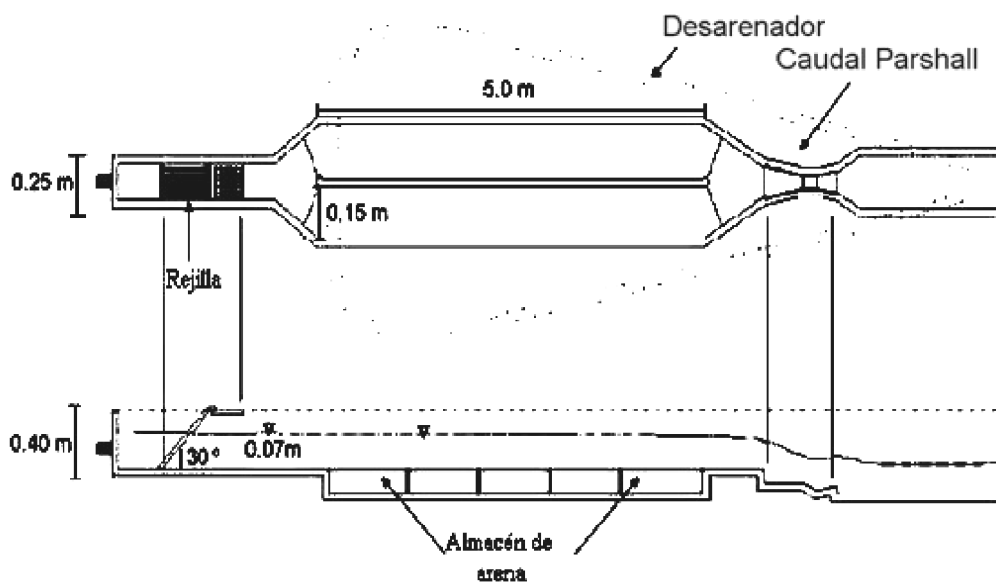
Esquemas de rejillas y desarenador para la Planta N°2
